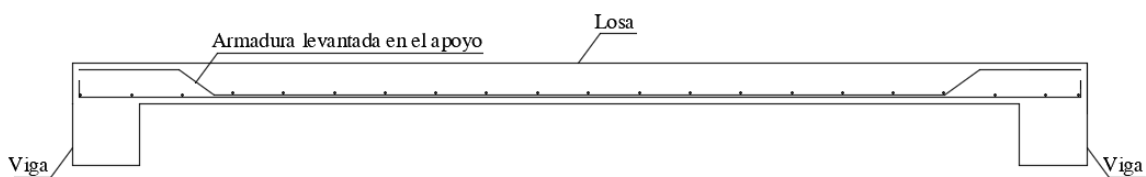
Esquema de losa con armadura levantada en el apoyo.
